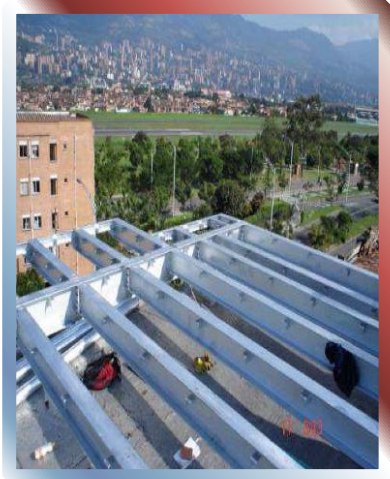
y 127 – Plataforma Metálica sobre edificio.
